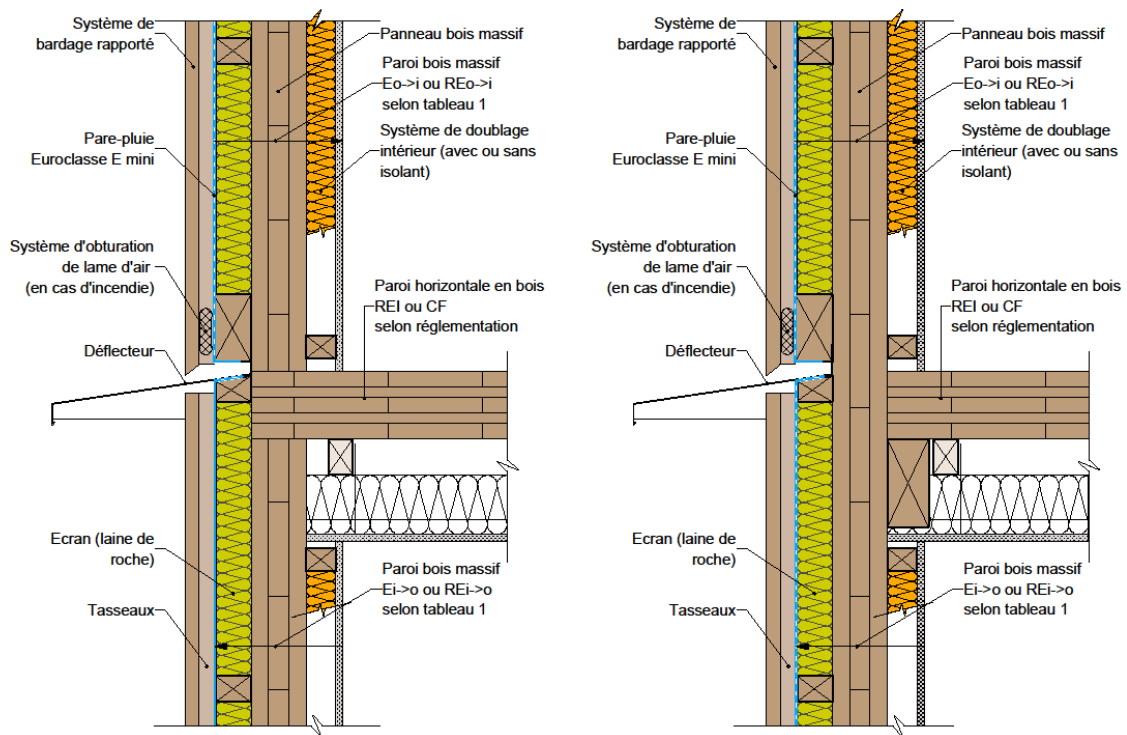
Façade/mur en panneaux bois massif & plancher en panneau bois massif.
